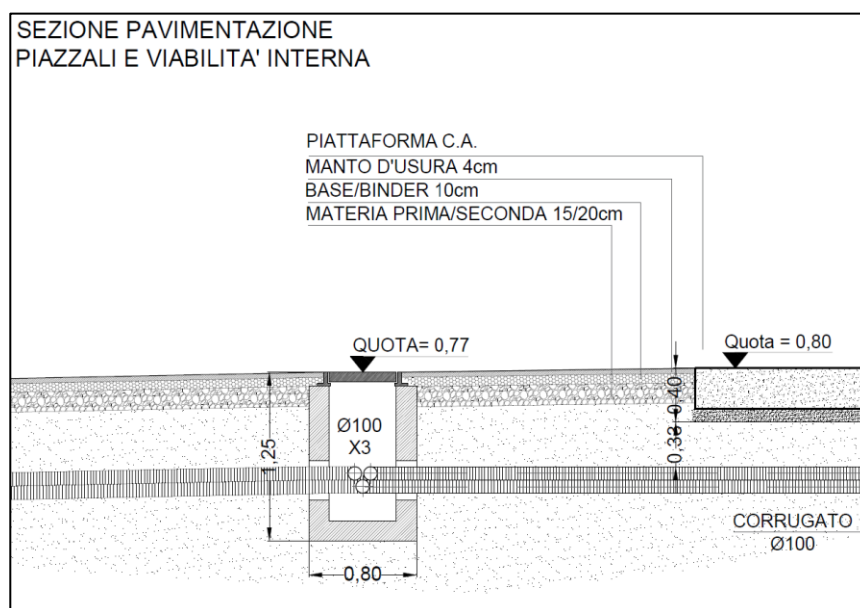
Particolare Pavimentazione in conglomerato
